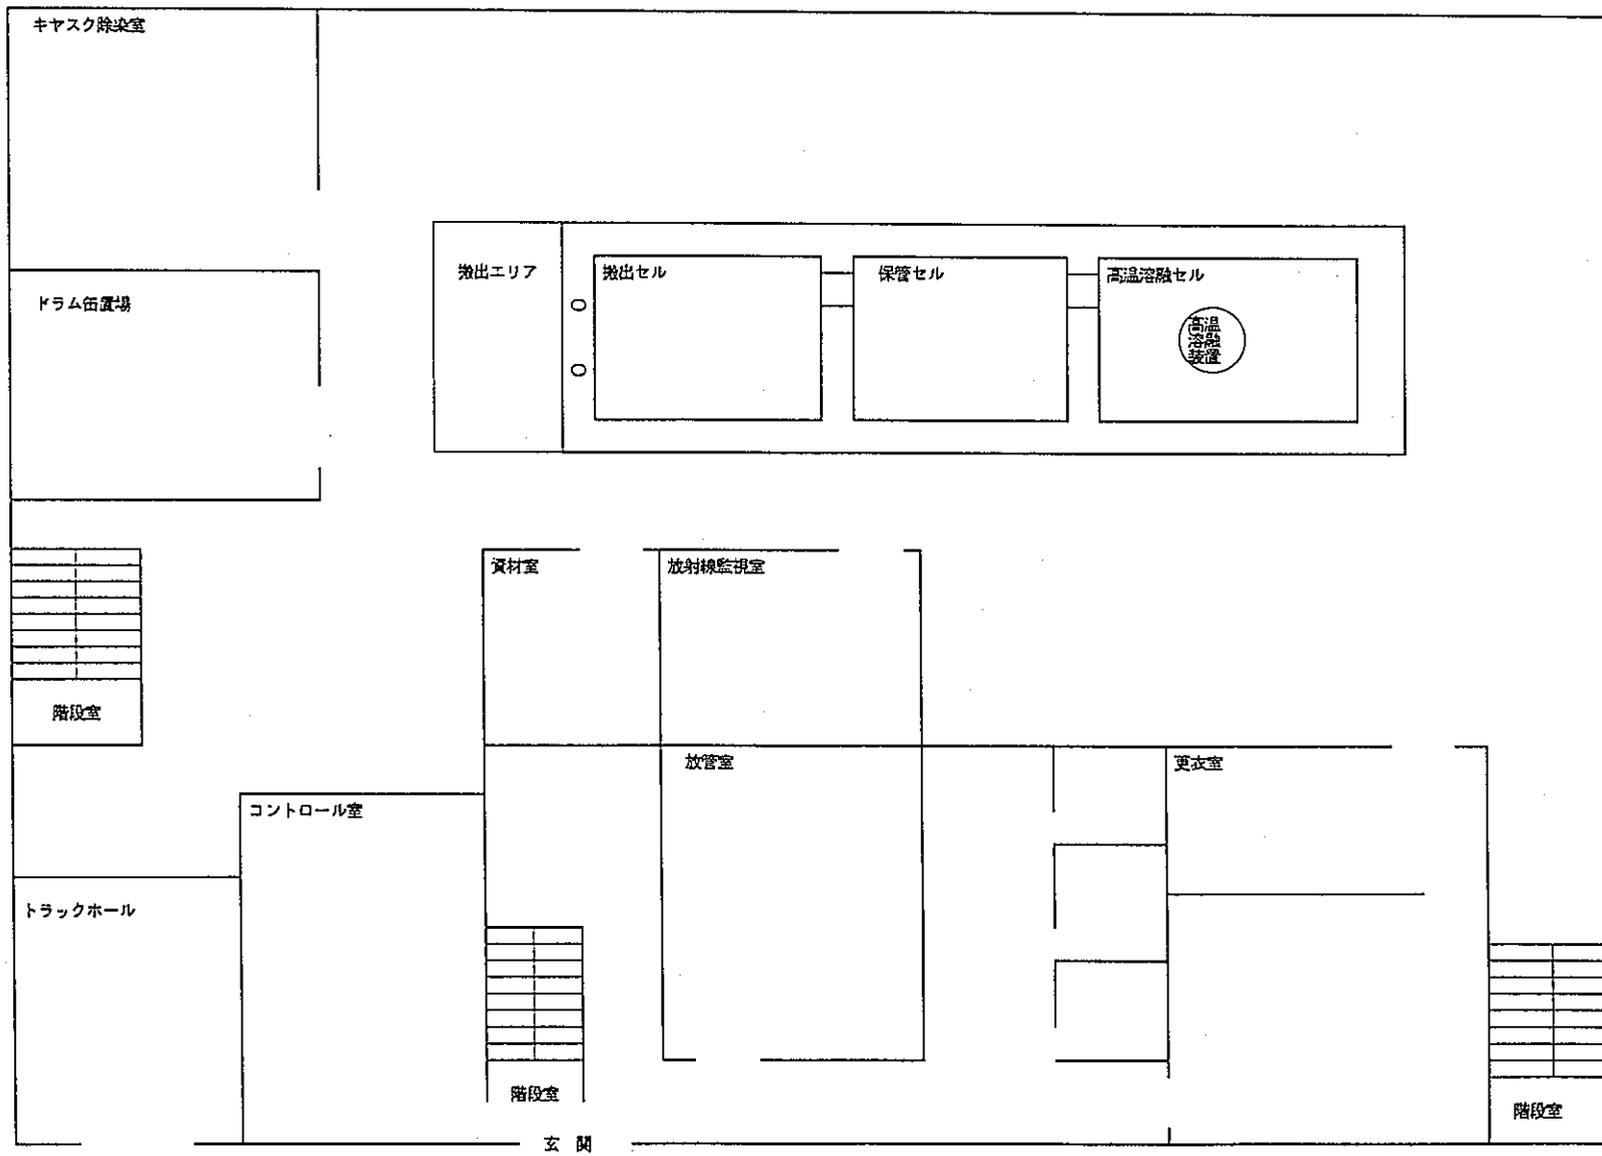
高温・高圧固体廃棄物処理装置中核燃料格納庫 (1階) 平面図 (2 / 4)
